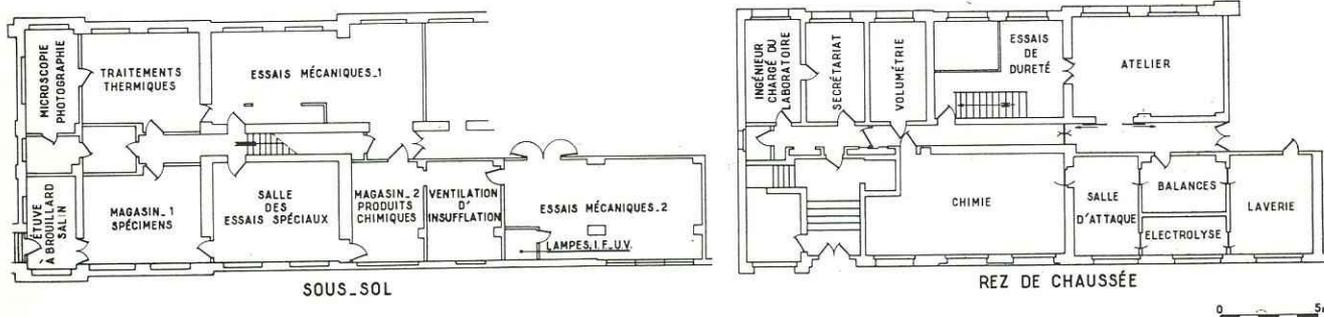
2 et 3. — Plans du laboratoire d'essais.
